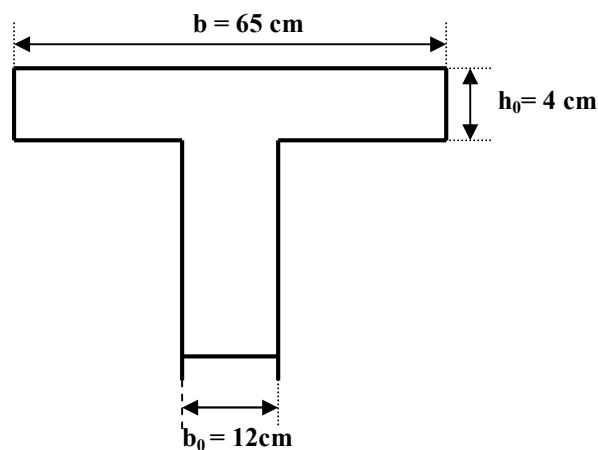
Dimensions des poutrelles du plancher en corps creux.
